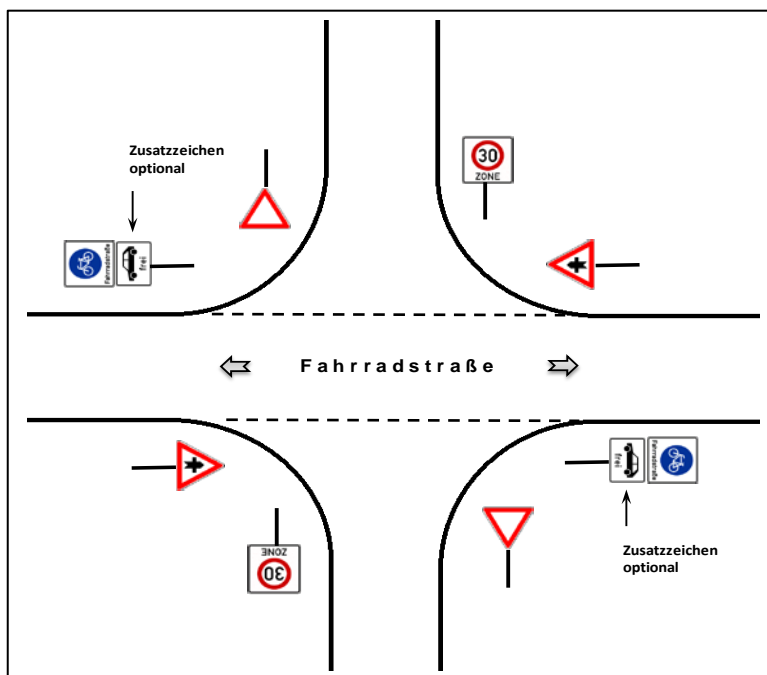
Beschilderungsplan bevorrechtigte Fahrradstraße
